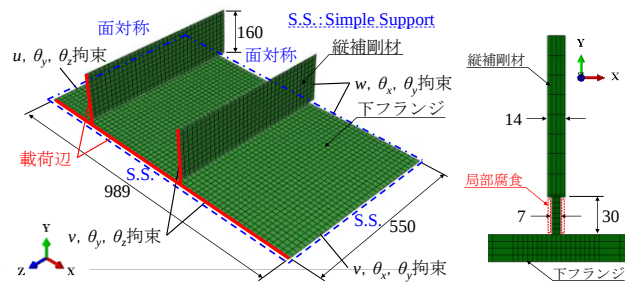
解析モデル(単位:mm) 図-4 局部腐食(単位:mm)
